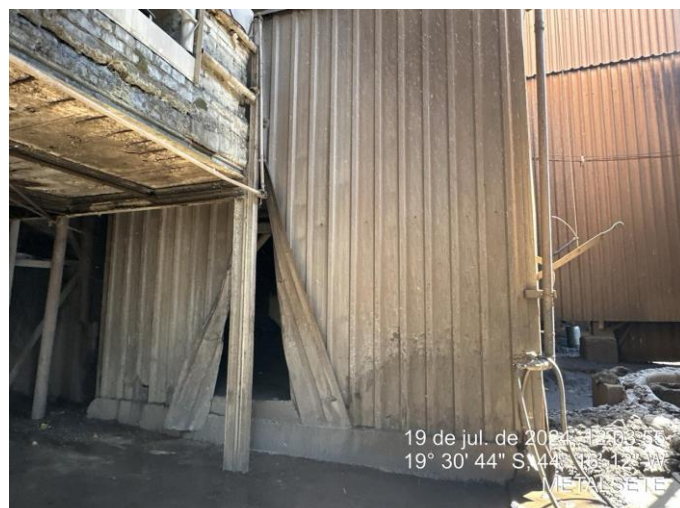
Local onde a caçamba que recebe pó seco está disposta;
